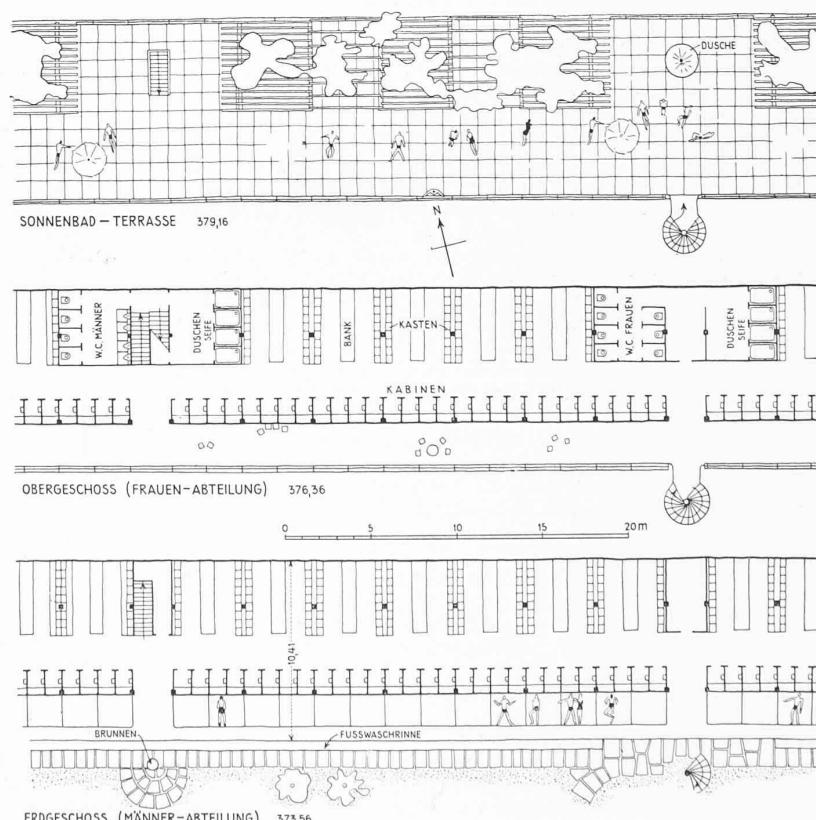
Grundrisse des Kabinentraktes. — Masstab 1:400
